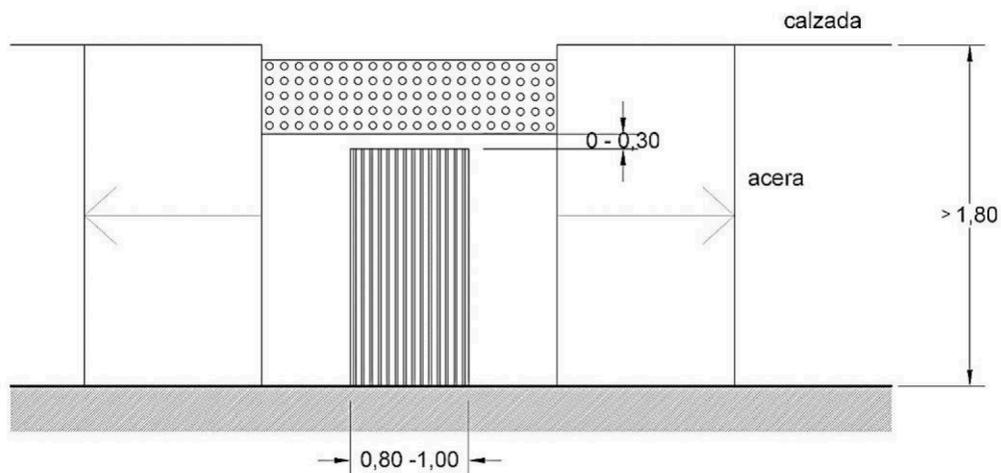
7. Cruce con vado deprimido en aceras de anchura superior a 1,80 m
